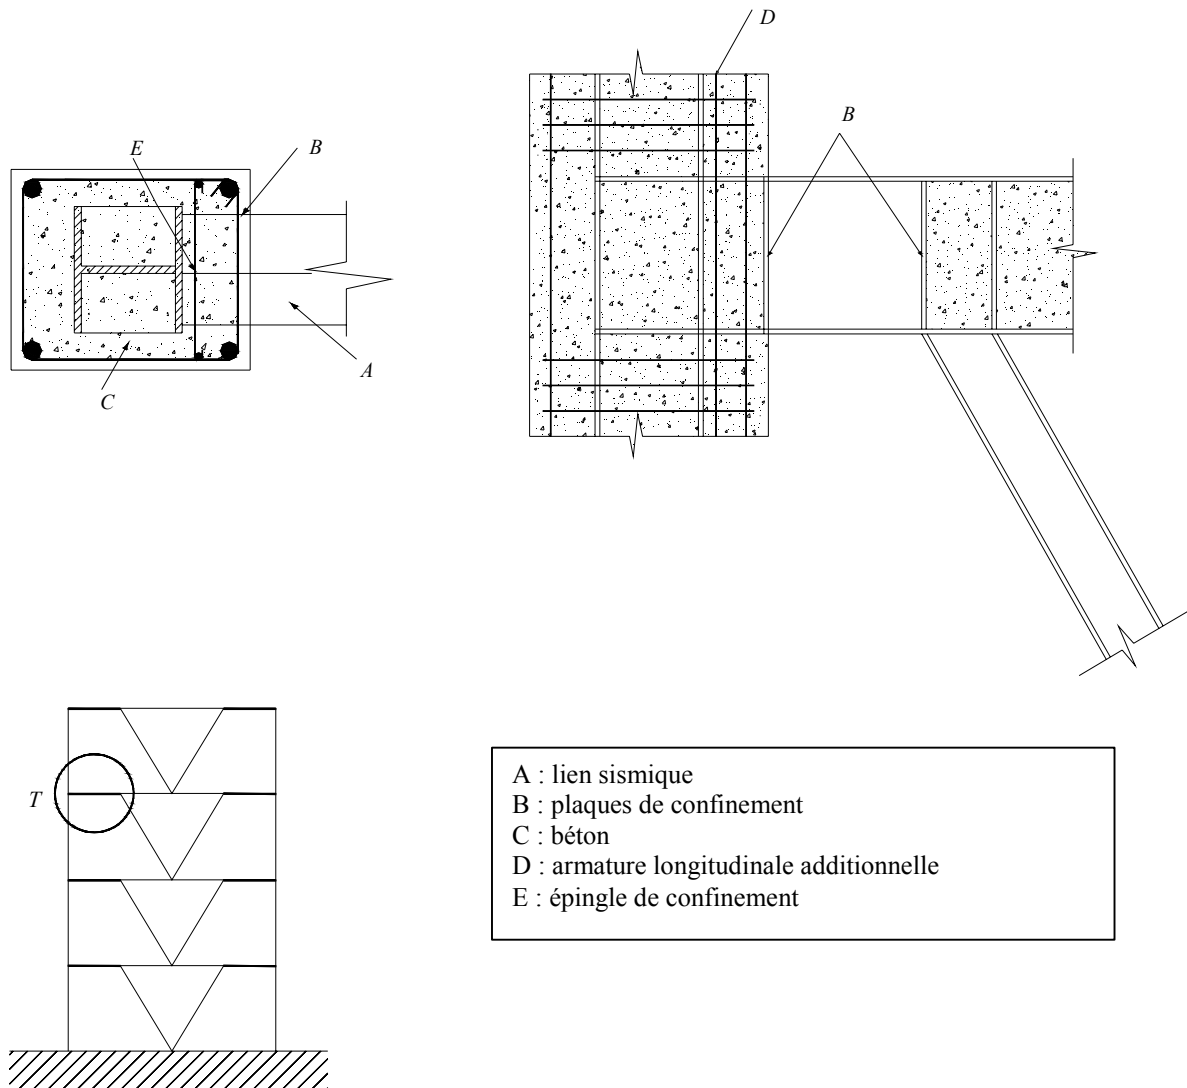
b. Détail de la zone T d'assemblage poutre – poteau – tronçon d'excentrement dans une ossature mixte à triangulation excentrée.
